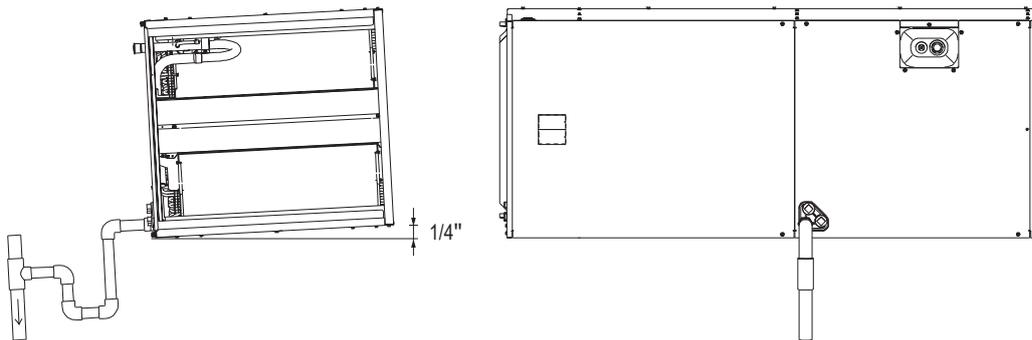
VISTA HORIZONTALMENTE IZQUIERDA
